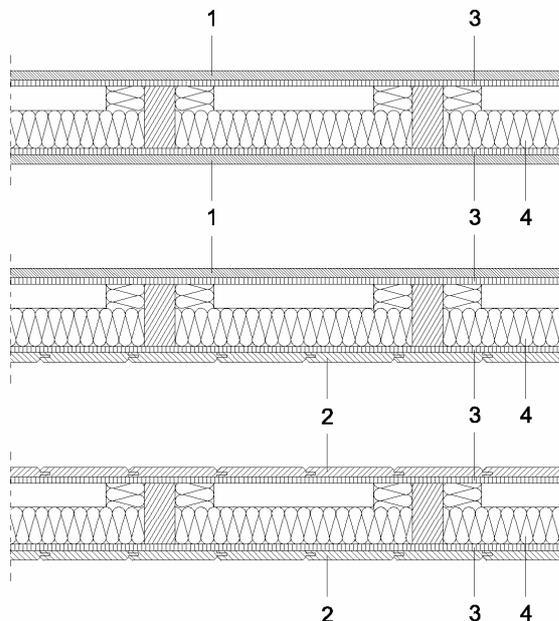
Sección transversal horizontal de paredes exteriores con revestimiento exterior de madera y placa de yeso laminado interior.
